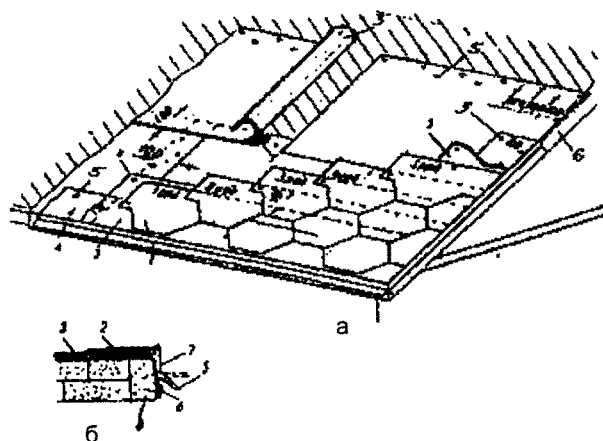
Конструктивное решение кровли из битумных плиток (шинглас)
